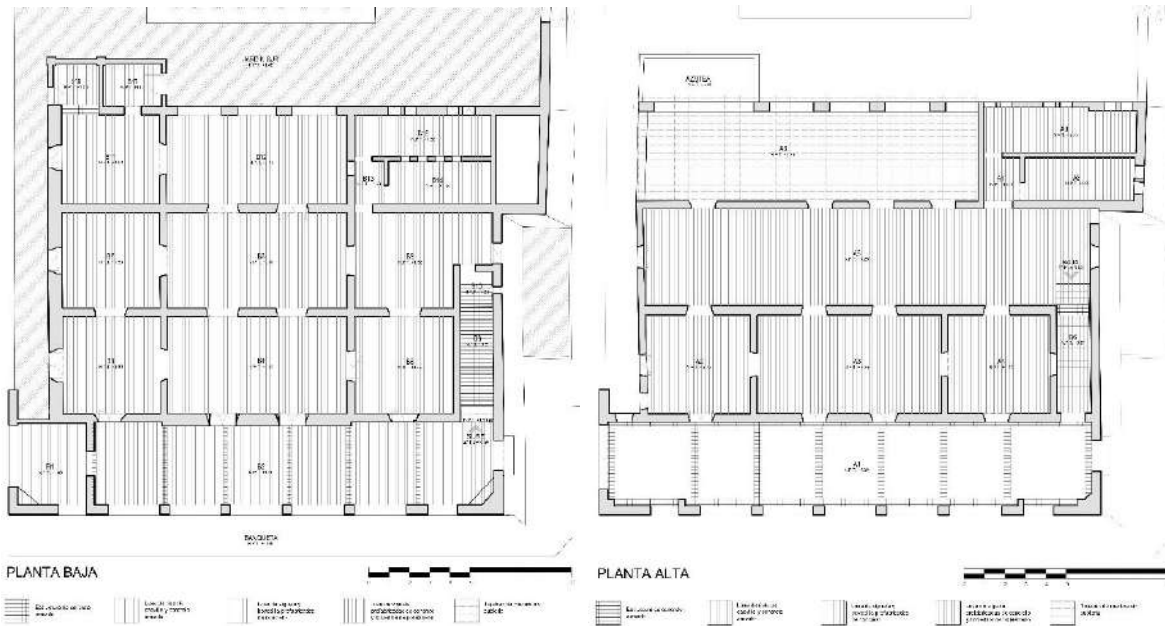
Plano de tipos de losas de planta baja y planta alta de edificio Xculucya 2017. Fuente: Elaboración propia.
